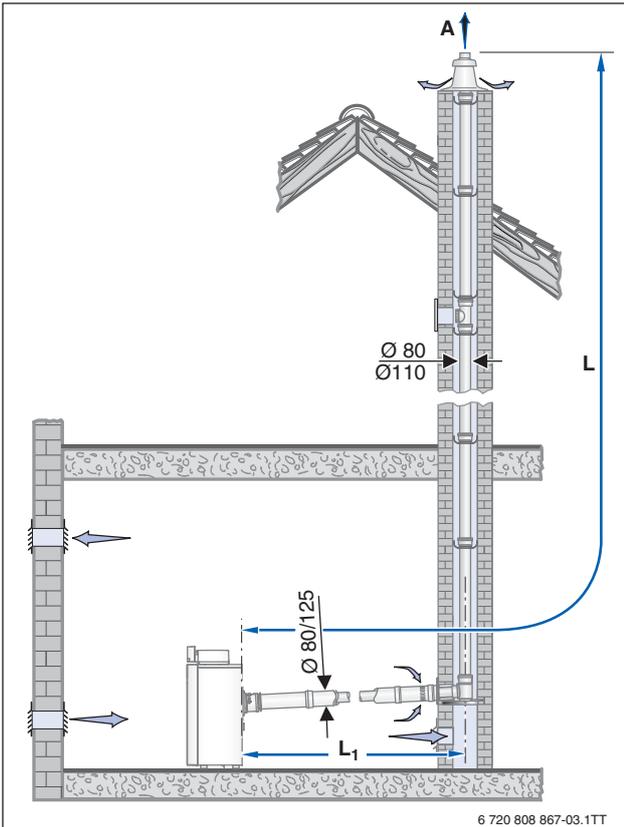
Montagevariante mit dem Bausatz GA-X + GA-K
